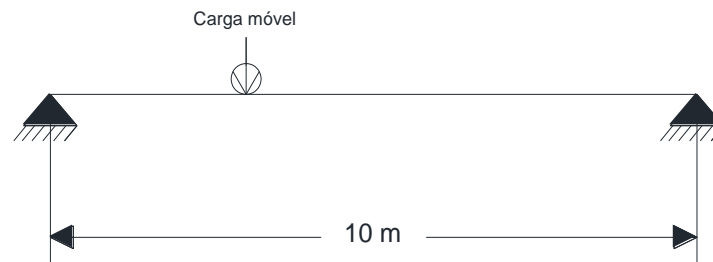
Viga simplesmente apoiada com carga móvel
